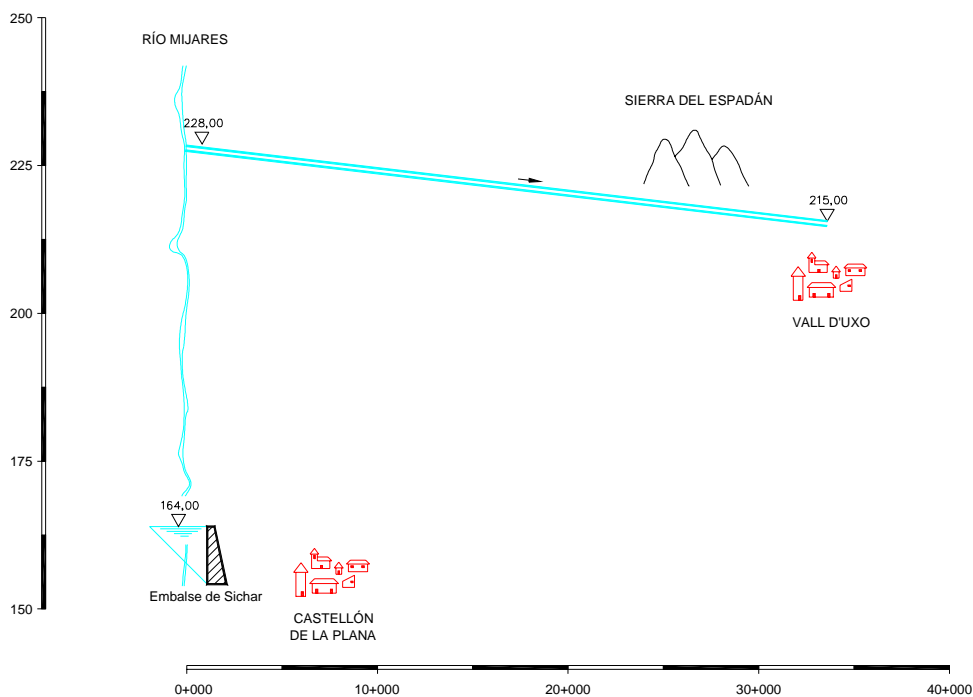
Conducción Mijares - Castellón Sur. Esquema en alzado.
